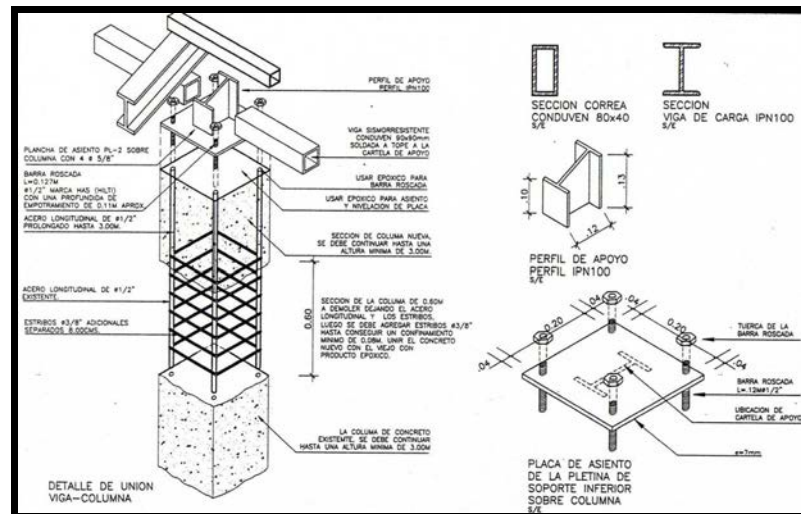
Detalle de prolongación de columna de concreto. Manual FEDE.
